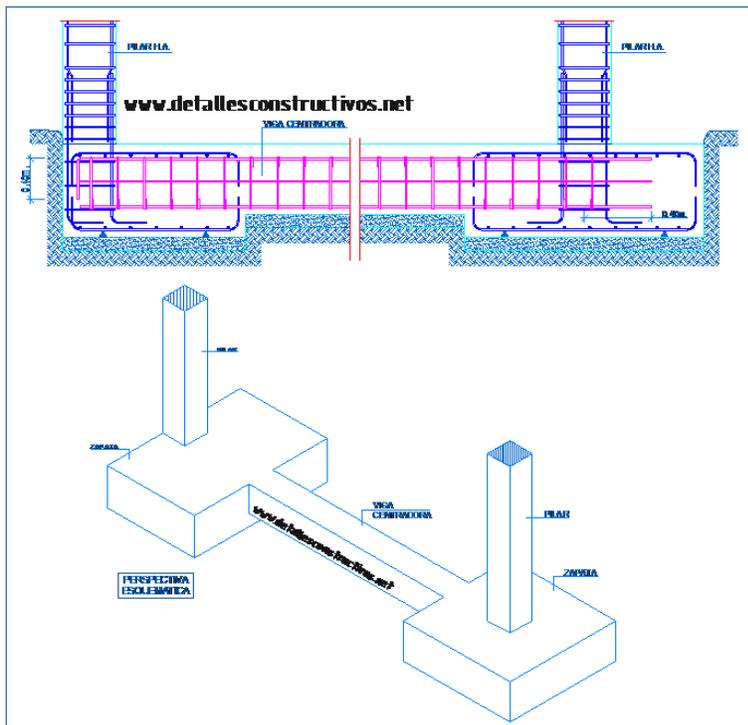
Detalle de Entrega de Viga Centrada a Zapata
